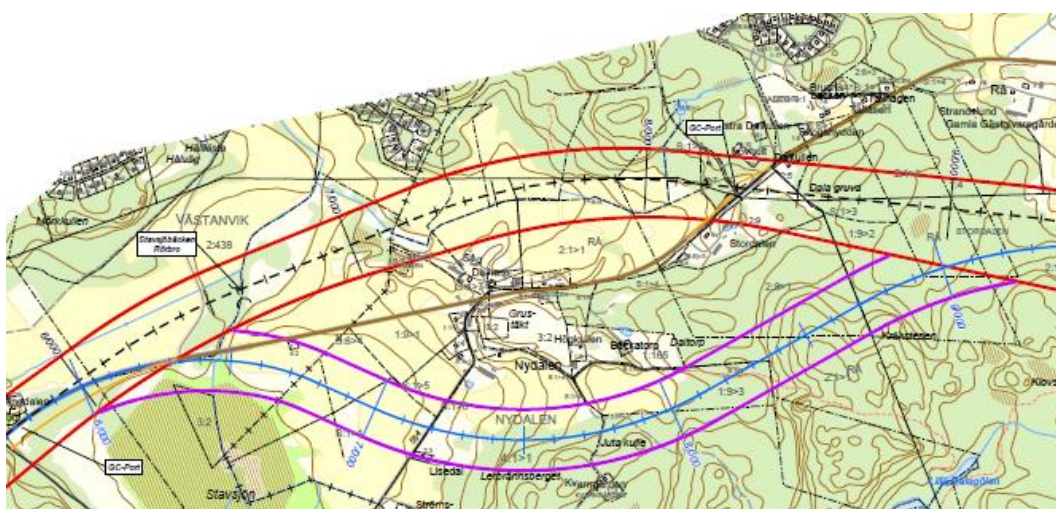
Alternativ 2 och 8 vid Nydalen km 6-10, plan.
